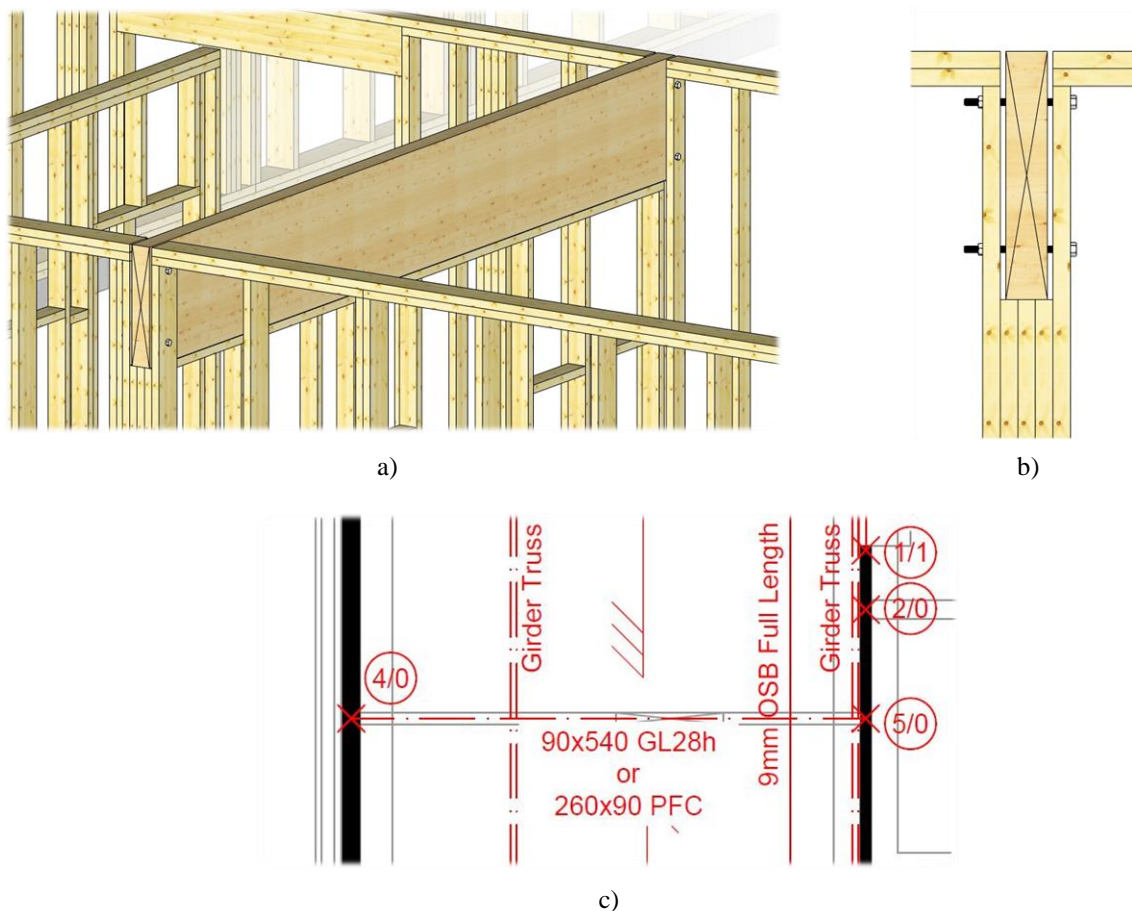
Viga em MLC utilizada no projeto de referência: a) localização da viga, inserida numa parede interna; b) secção transversal; c) marcação estrutural 2D
